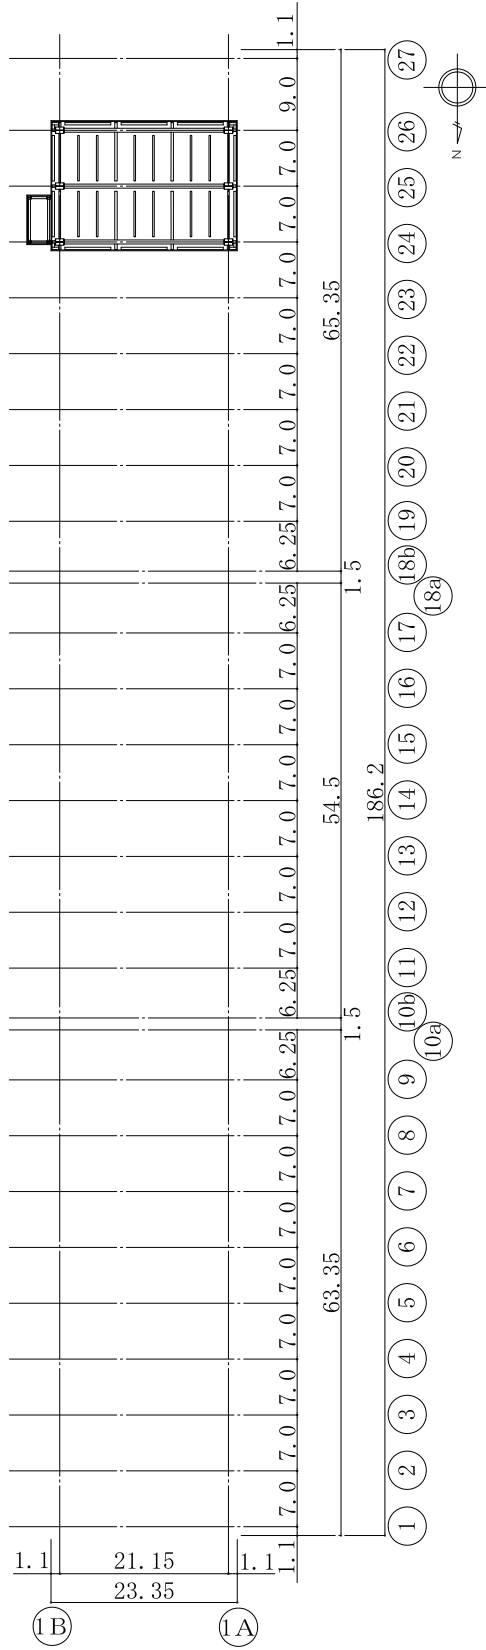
屋上階平面圖 (G. L. +22.850) (单位 : m)
